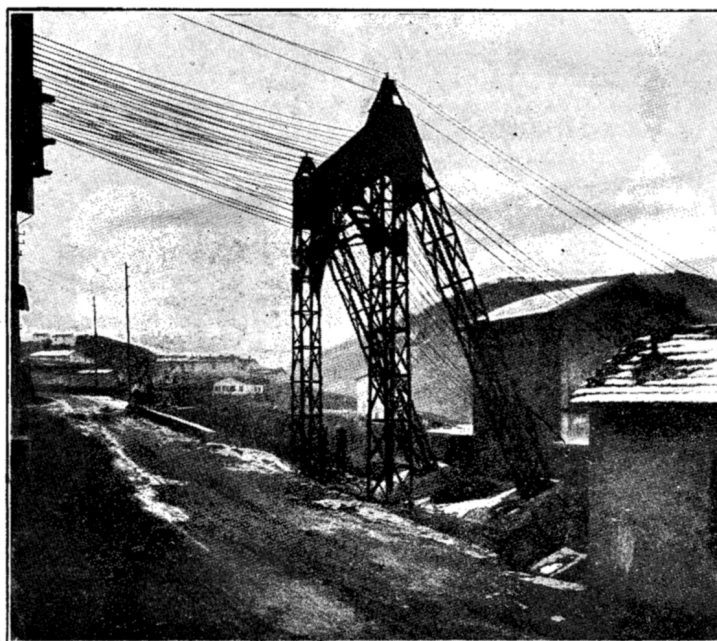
Pilone d'ammarraggio delle linee a bassa tensione all'uscita dalle cabine ai pozzi.
